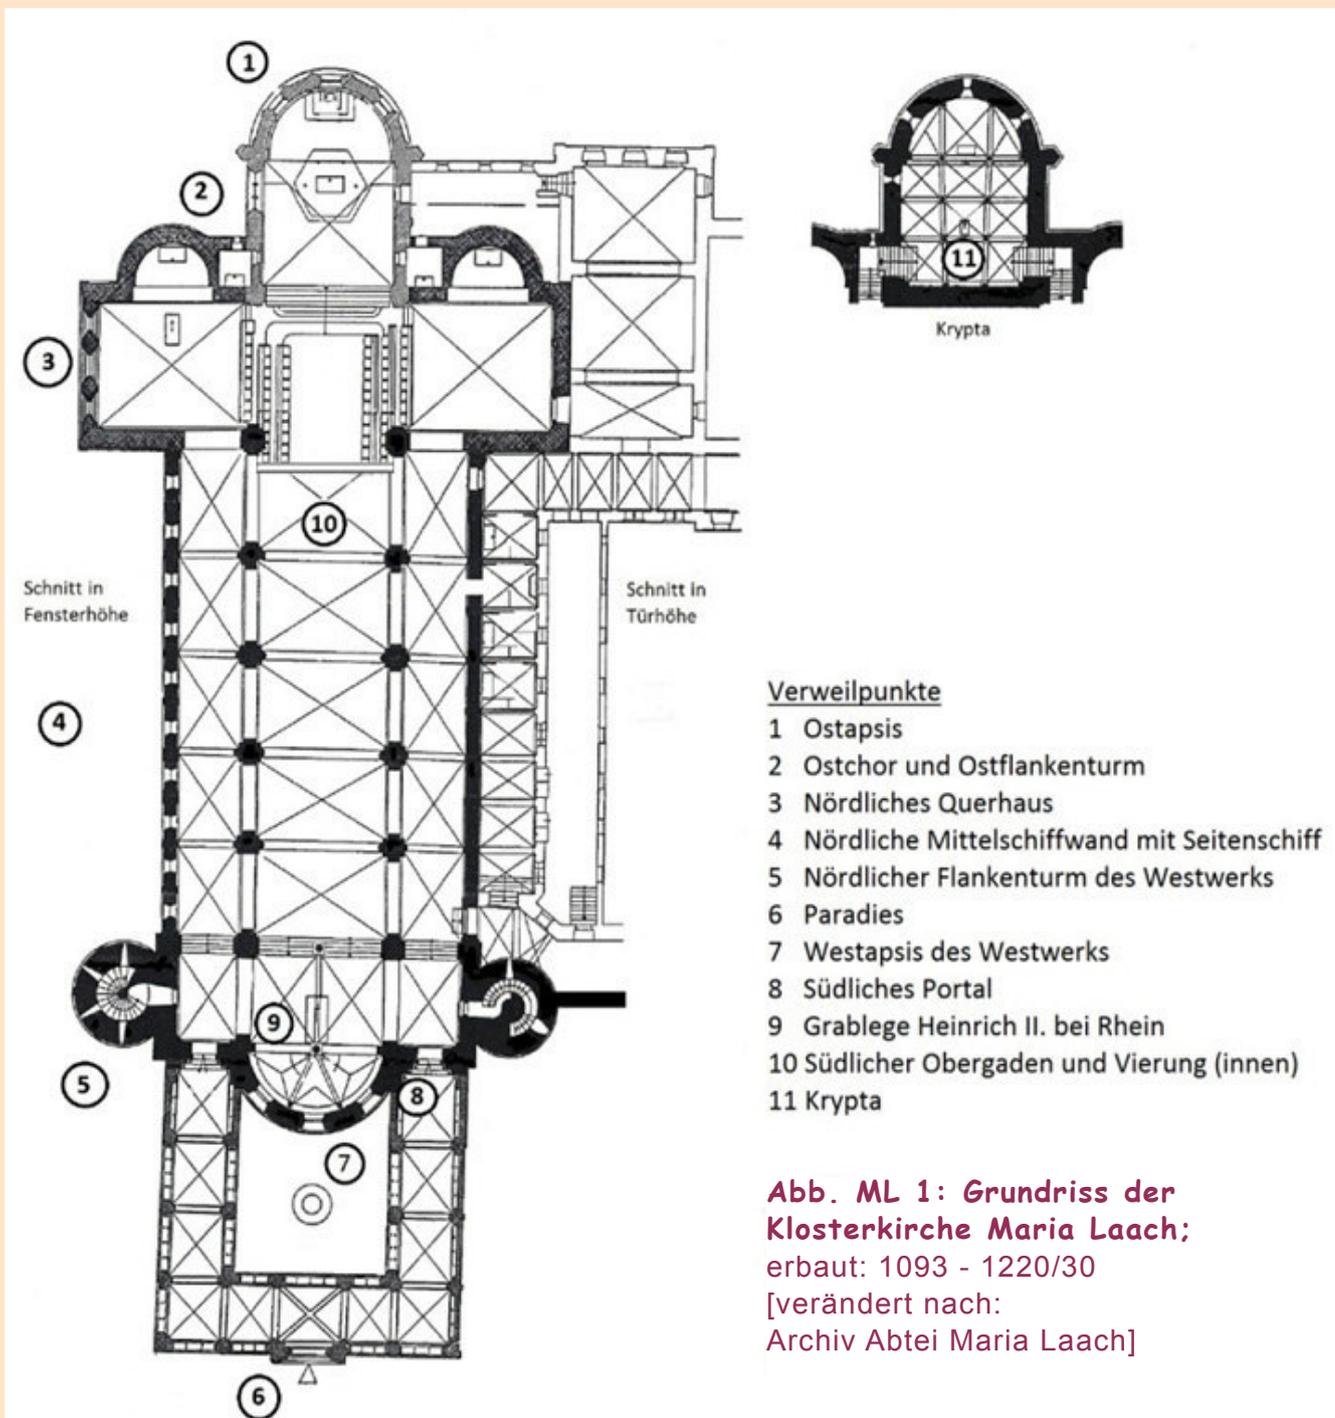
Grundriss der Klosterkirche Maria Laach;
